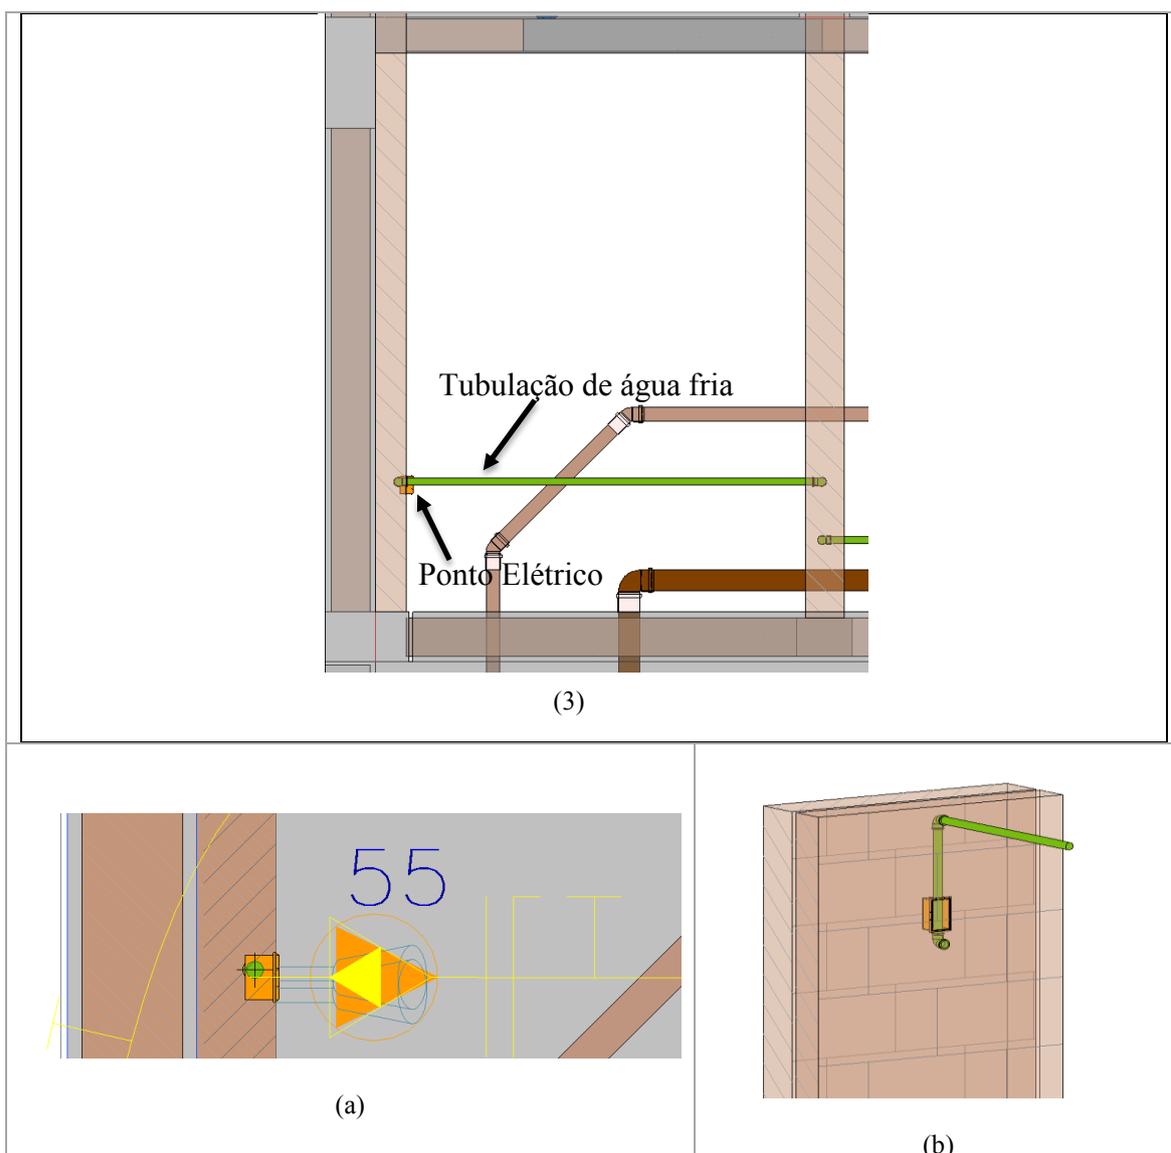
Confronto entre ponto elétrico e tubulação de água fria em planta baixa (a) e em vista tridimensional (b). Fonte: elaborado pelos autores
